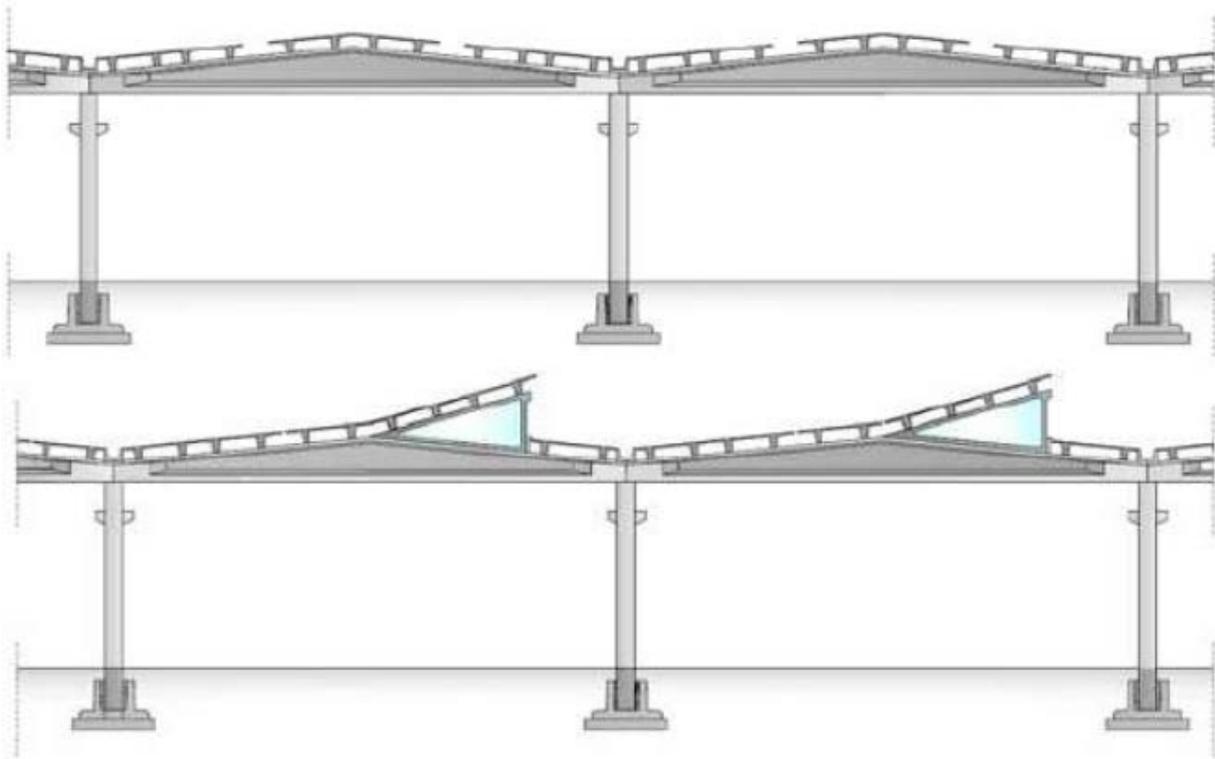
Esempi di copertura a doppia pendenza con tegoli nervati
